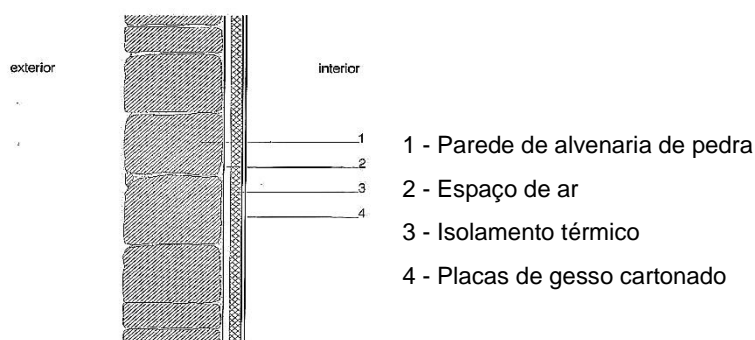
Esquema de isolamento pelo interior de parede de alvenaria de pedra [70]
